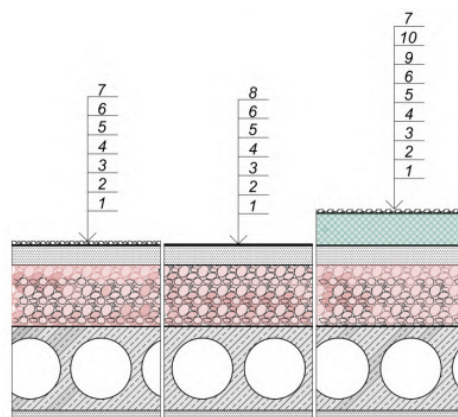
Схема ограждающей конструкции: 1 – штукатурка; 2 – железобетонная плита; 3 – пароизоляция; 4 – теплоизоляция; 5 – стяжка; 6 – гидроизоляция; 7 – защитный слой; 8 – композиционное покрытие «керамические микросферы – связующее»; 9 – теплоизоляция (дополнительный слой); 10 – гидроизоляция (дополнительный слой)
